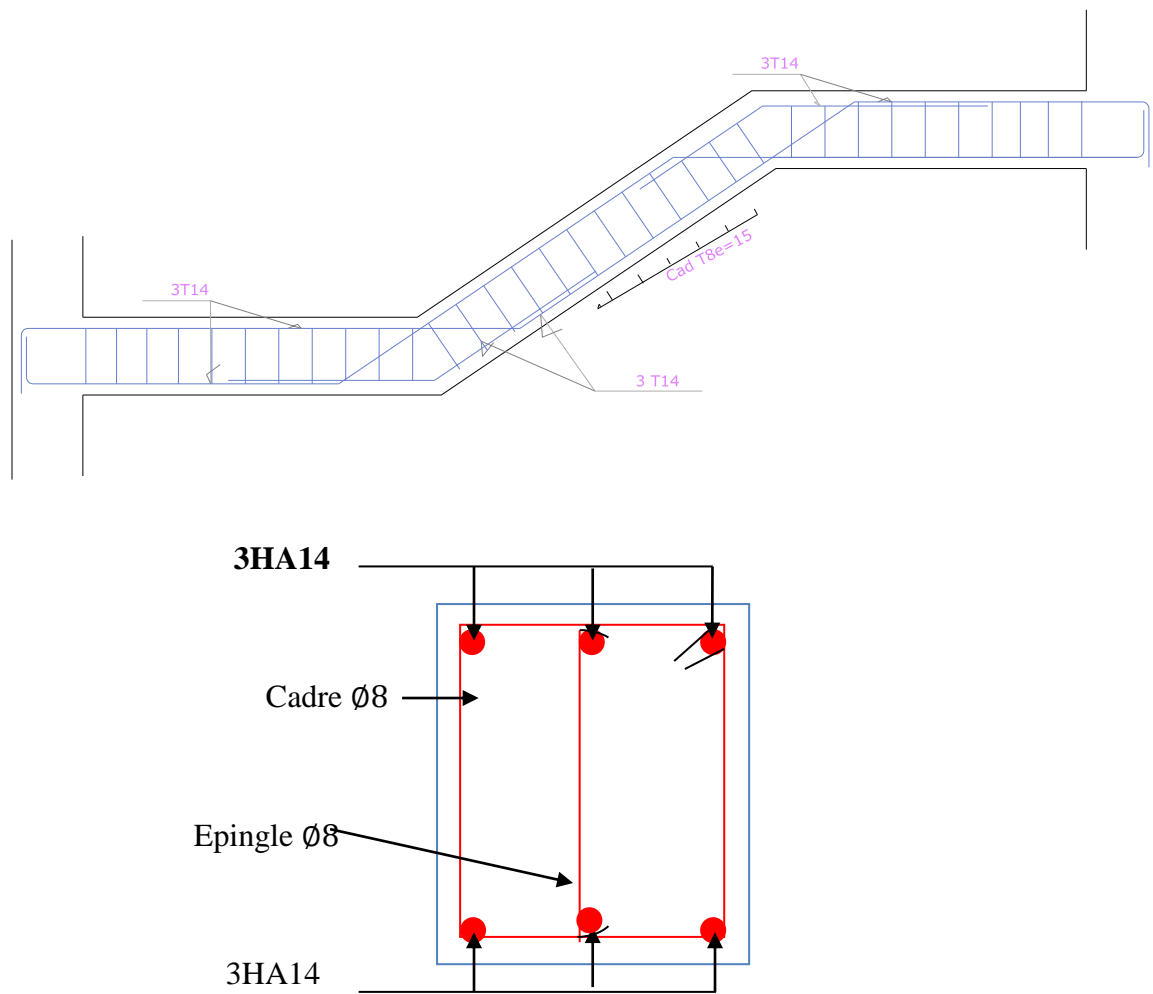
9: Schéma de ferrailage de la poutre palière brisée
